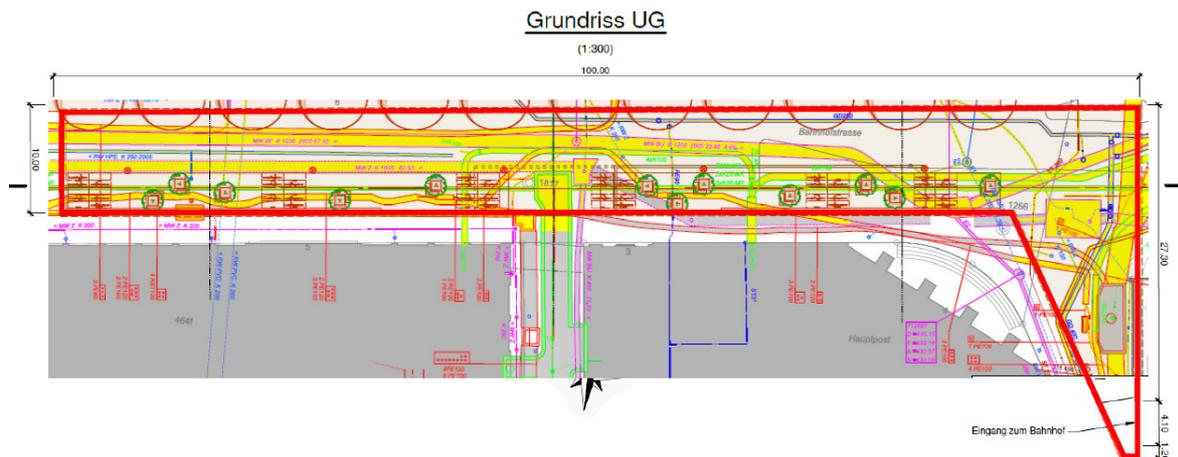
Grundriss Velostation rot und Friktionen mit bestehenden Leitungen gelb
